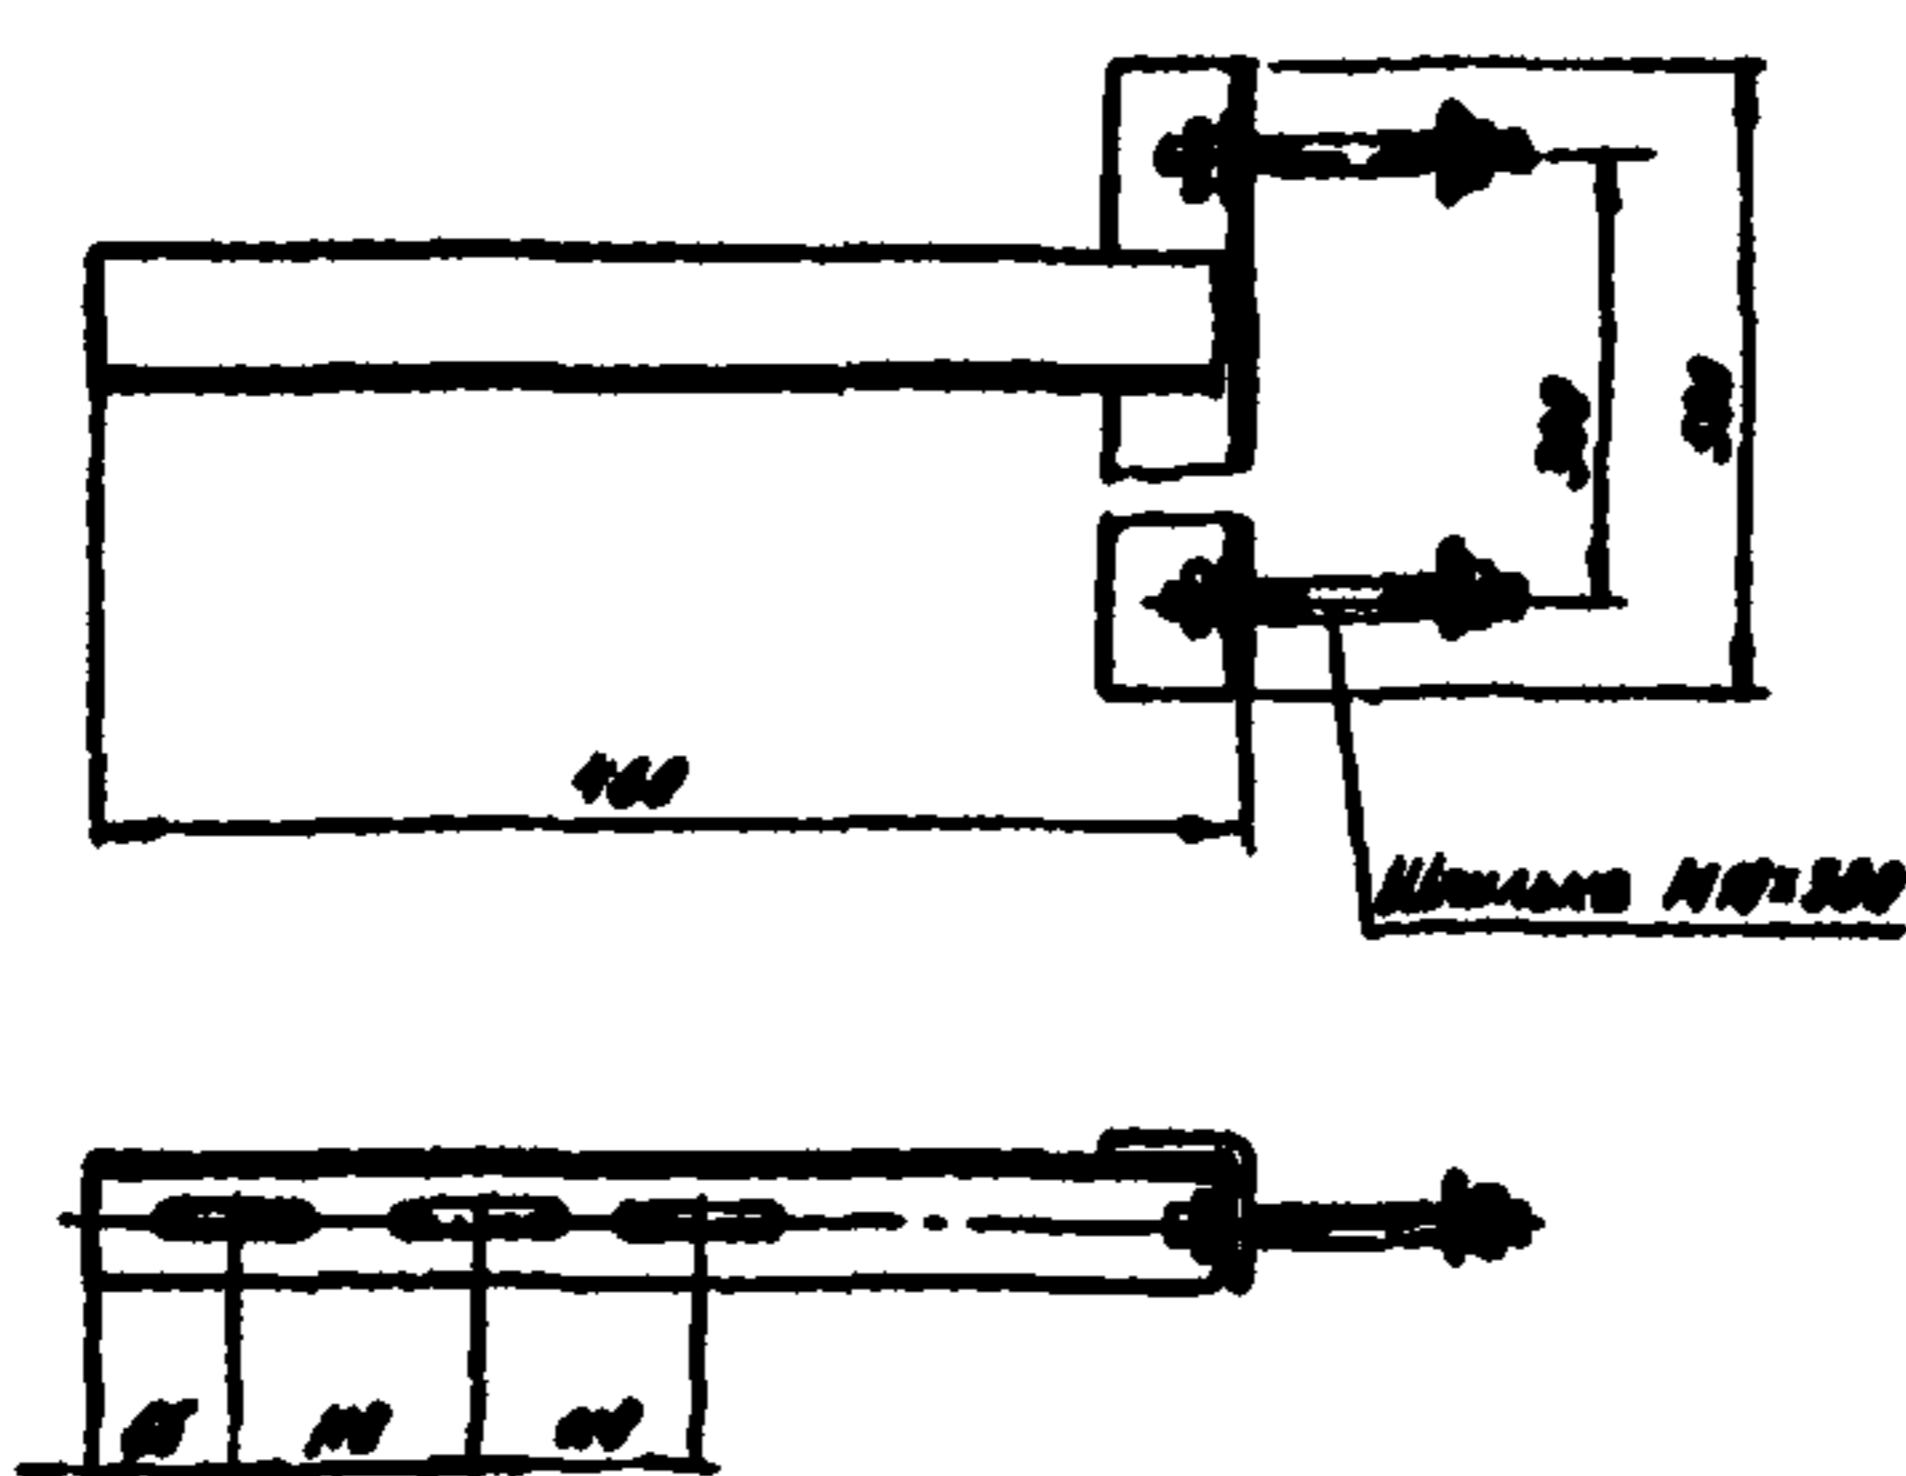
Кронштейн У3046 для крепления монотроллейных шинопроводов к железобетонным подкрановым балкам.
